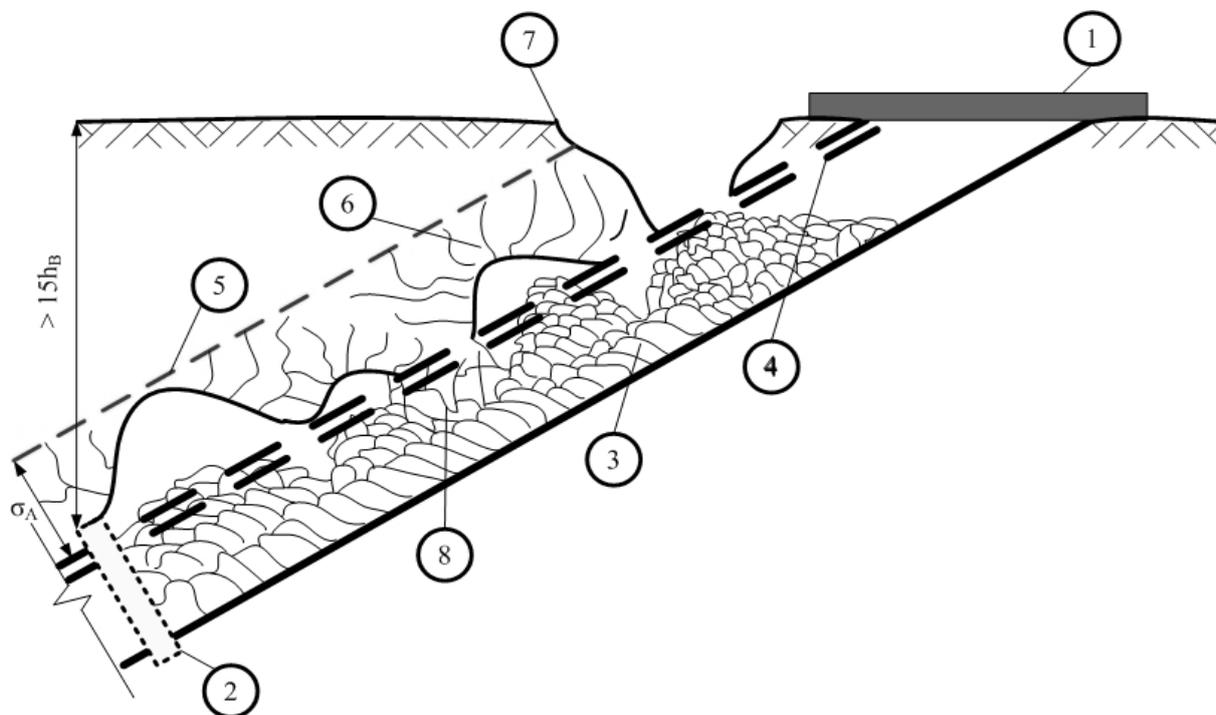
Схема фактического состояния наклонных шахтных стволов закрытых угольных шахт: 1 - полок перекрытия устья ствола; 2 - изолирующая перемычка, подвергшаяся разрушению; 3 - закладочный материал, частично вынесенный в прилегающие выработки; 4 - крепь ствола, подвергшаяся разрушению; 5 - граница зоны активных деформаций; 6 - купол обрушения; 7 - воронка провалообразования; 8 - зона пережима горных пород
